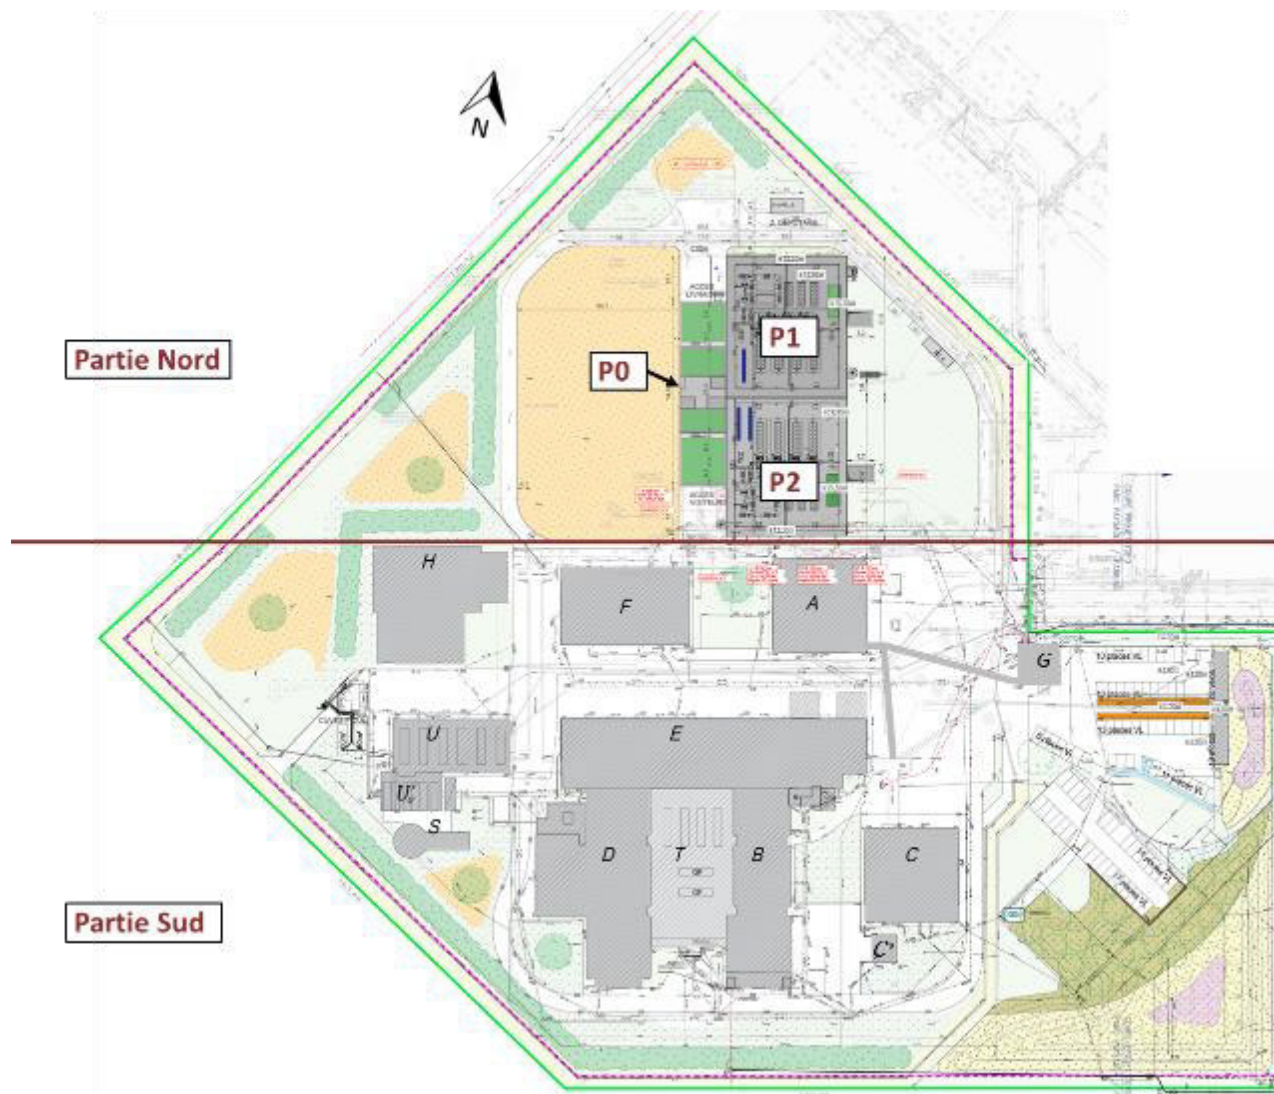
Plan de masse du site dans sa configuration projetée avec P2
